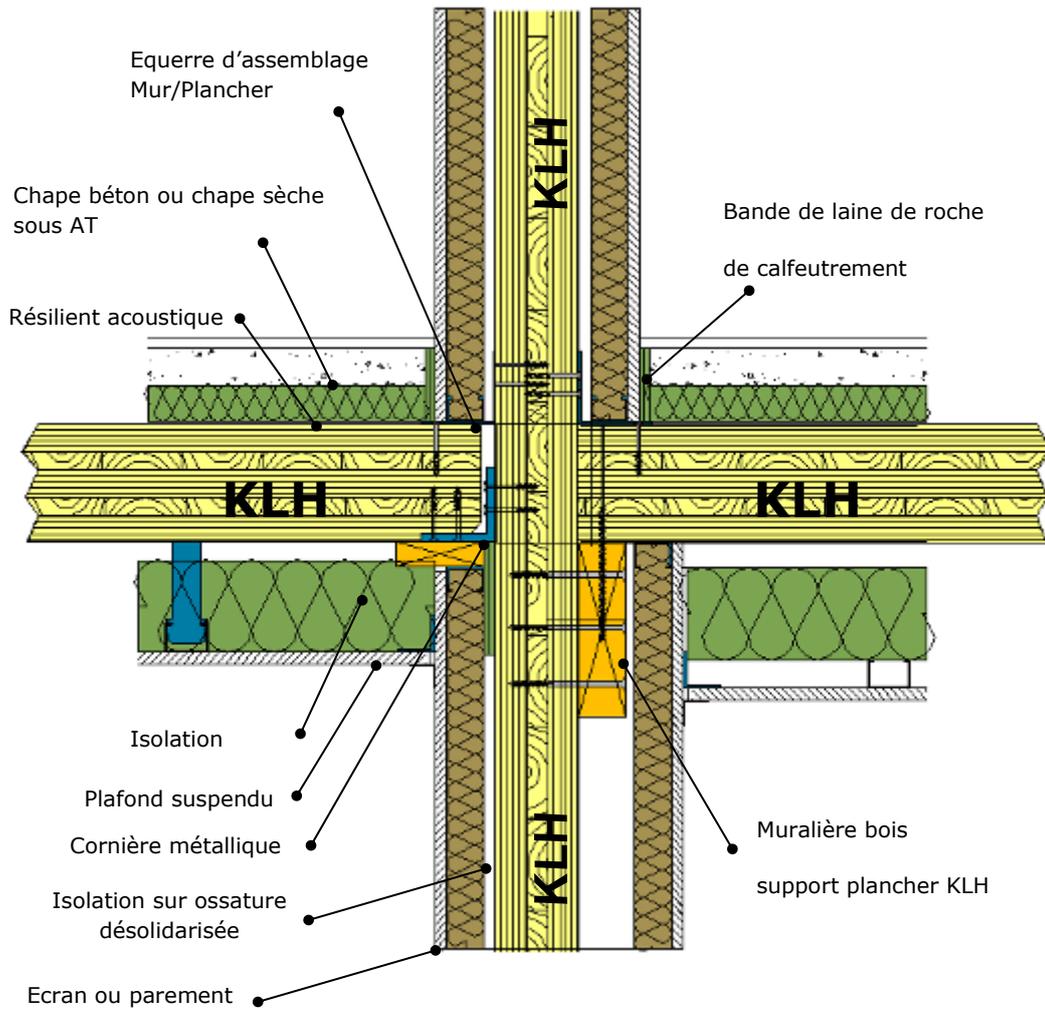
Coupe verticale sur locaux mitoyens et superposés avec plancher interrompu
